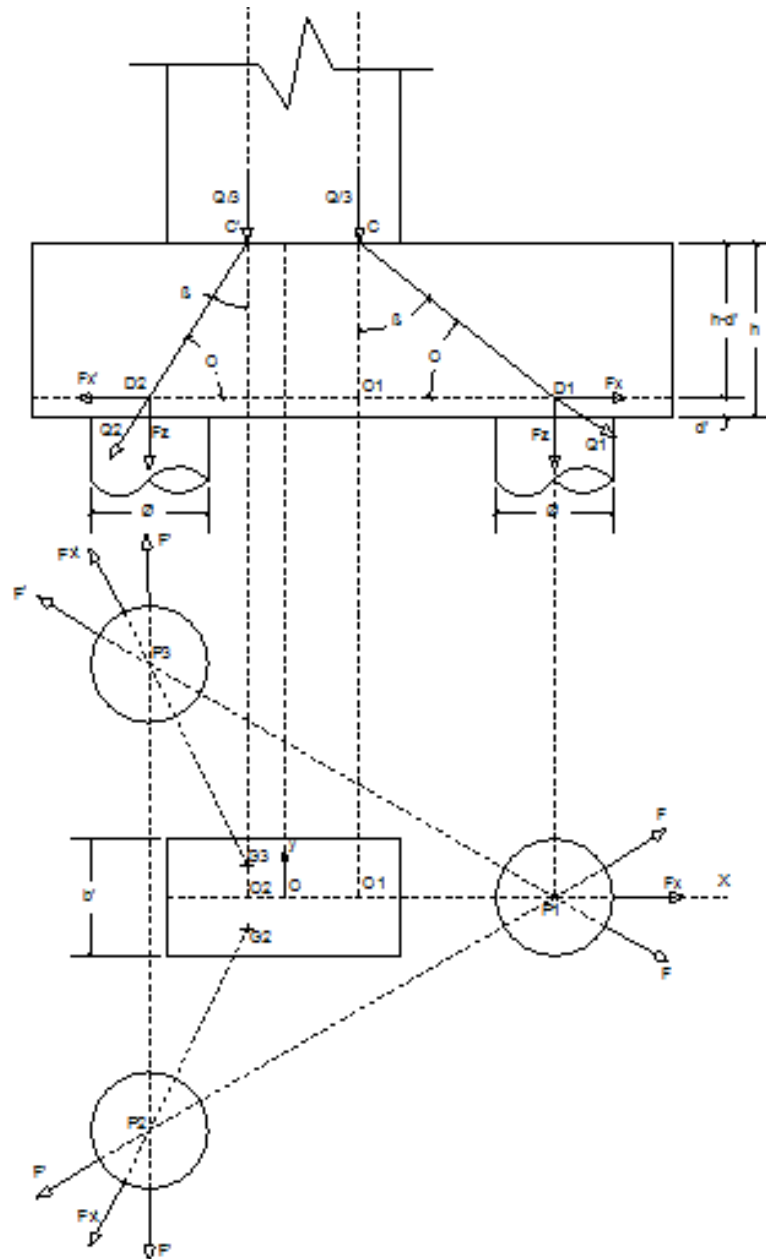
19: Método de las bielas para cabezales sobre tres pilotes- columna rectangular.
